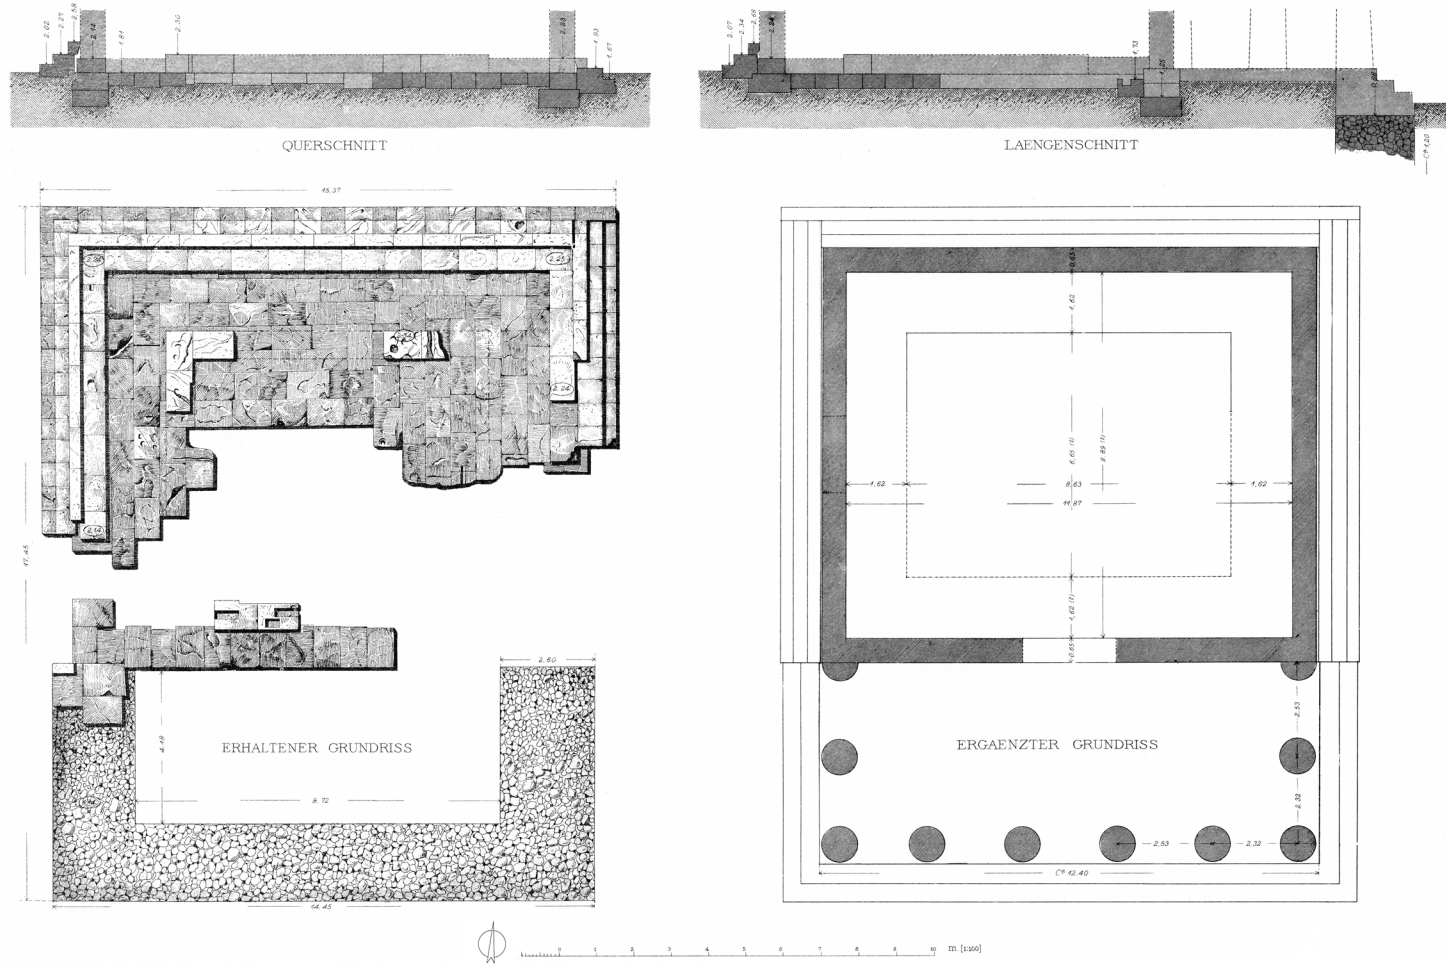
Steinplan, rekonstruierter Grundriss und Aufrisse des Schatzhauses von Gela (M. 1 : 200)
